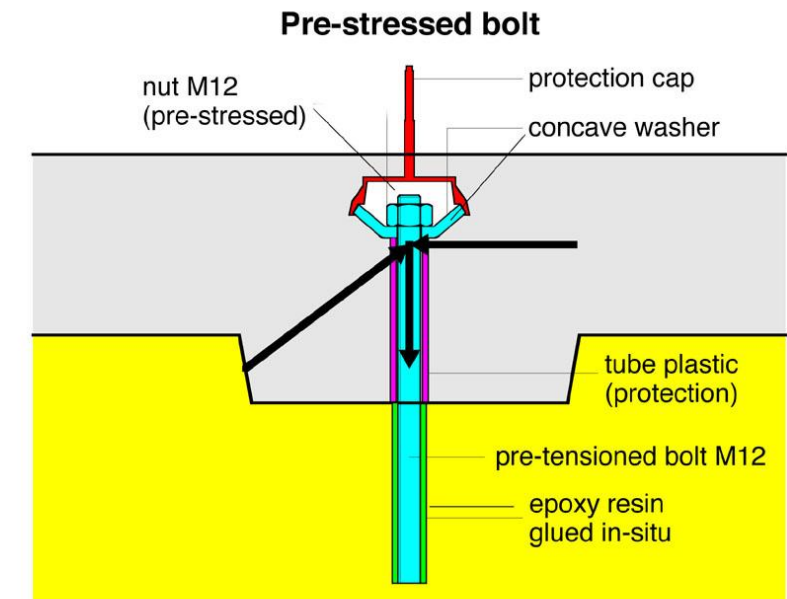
Dalle mixte bois-béton avec rainures.
